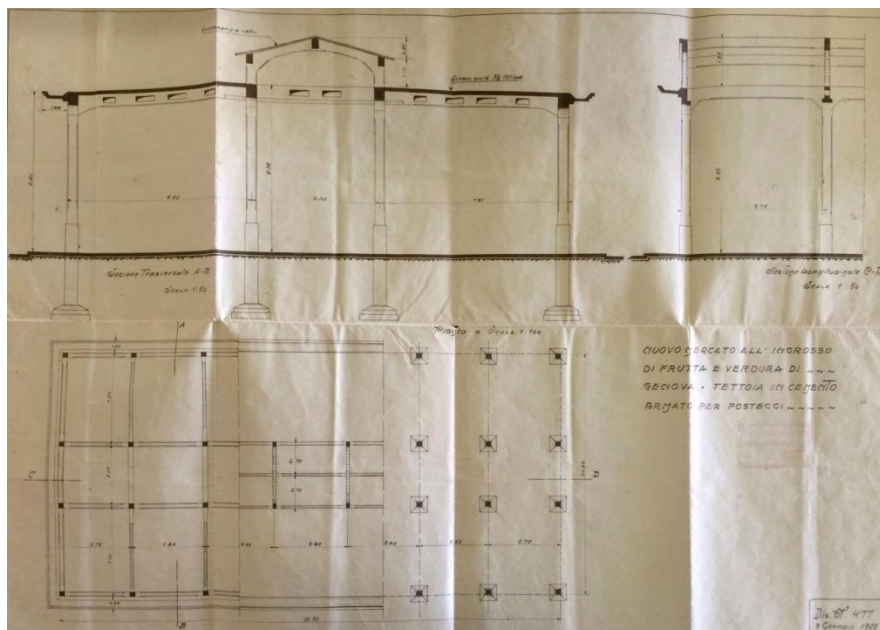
Presunto progetto prima tettoia (1926)-Archivio storico
